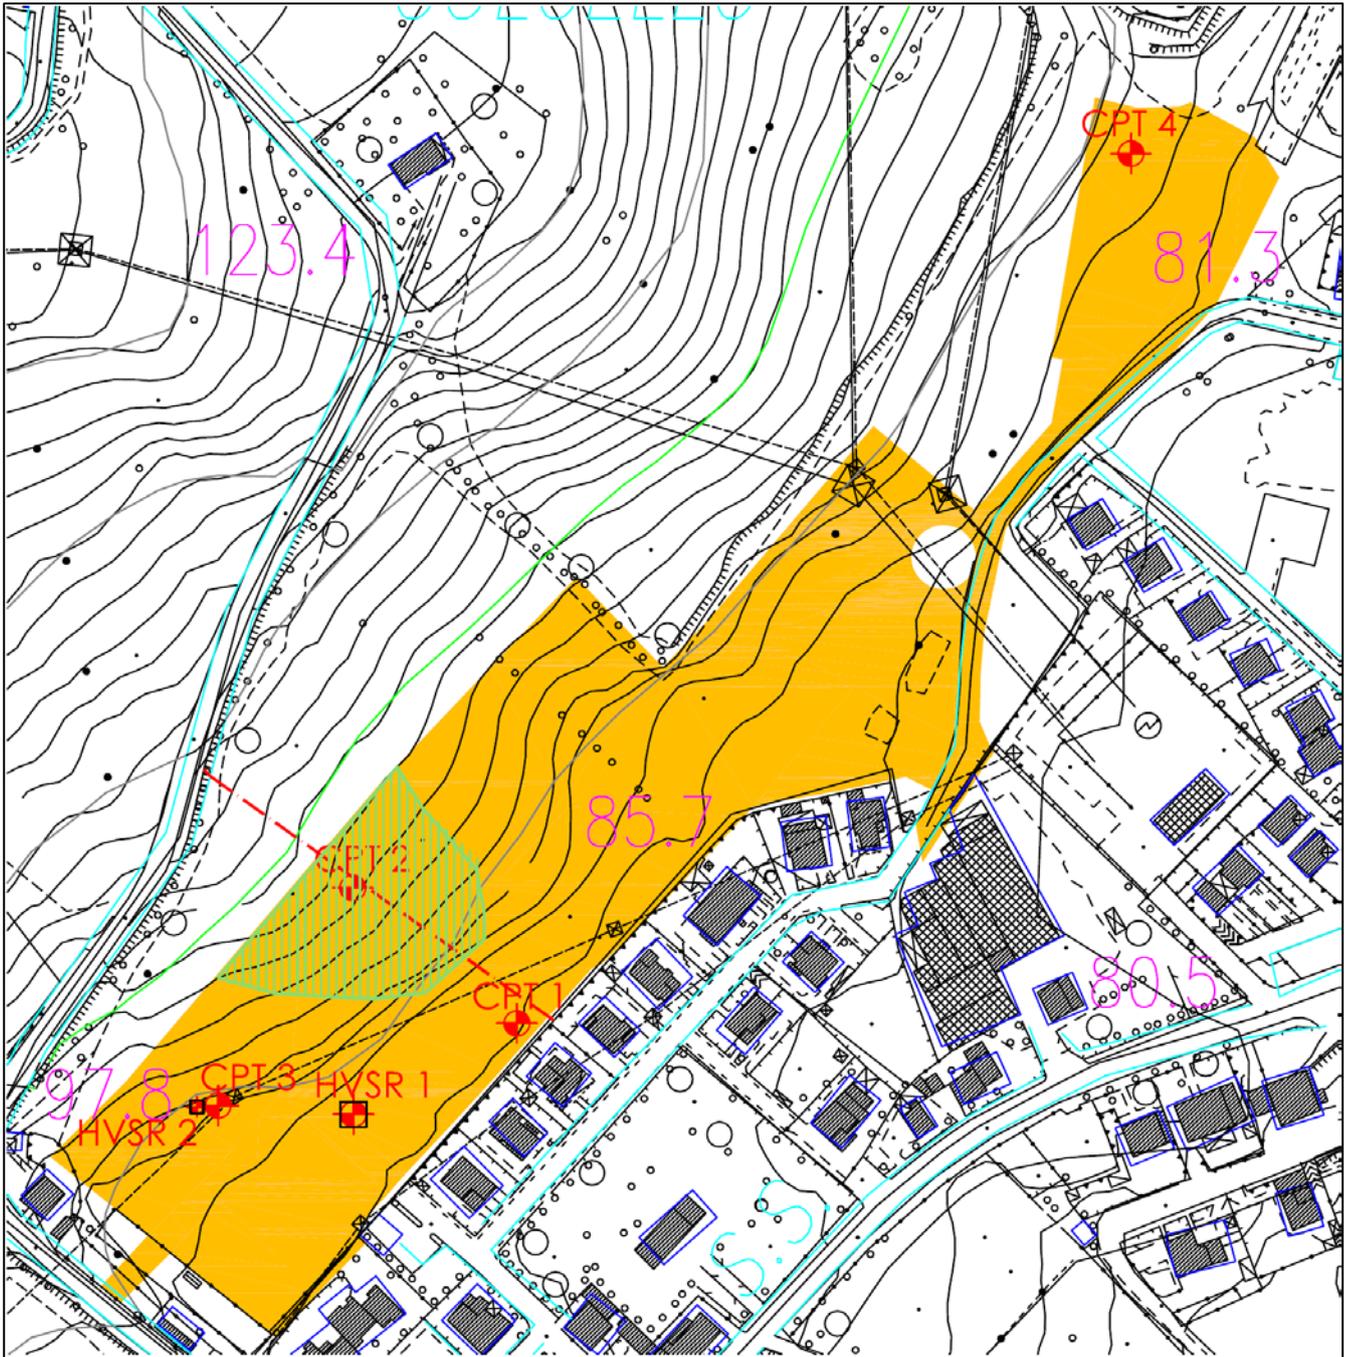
Planimetria comparto con in verde evidenziata l'area da riservare a verde privato o verde standards.
